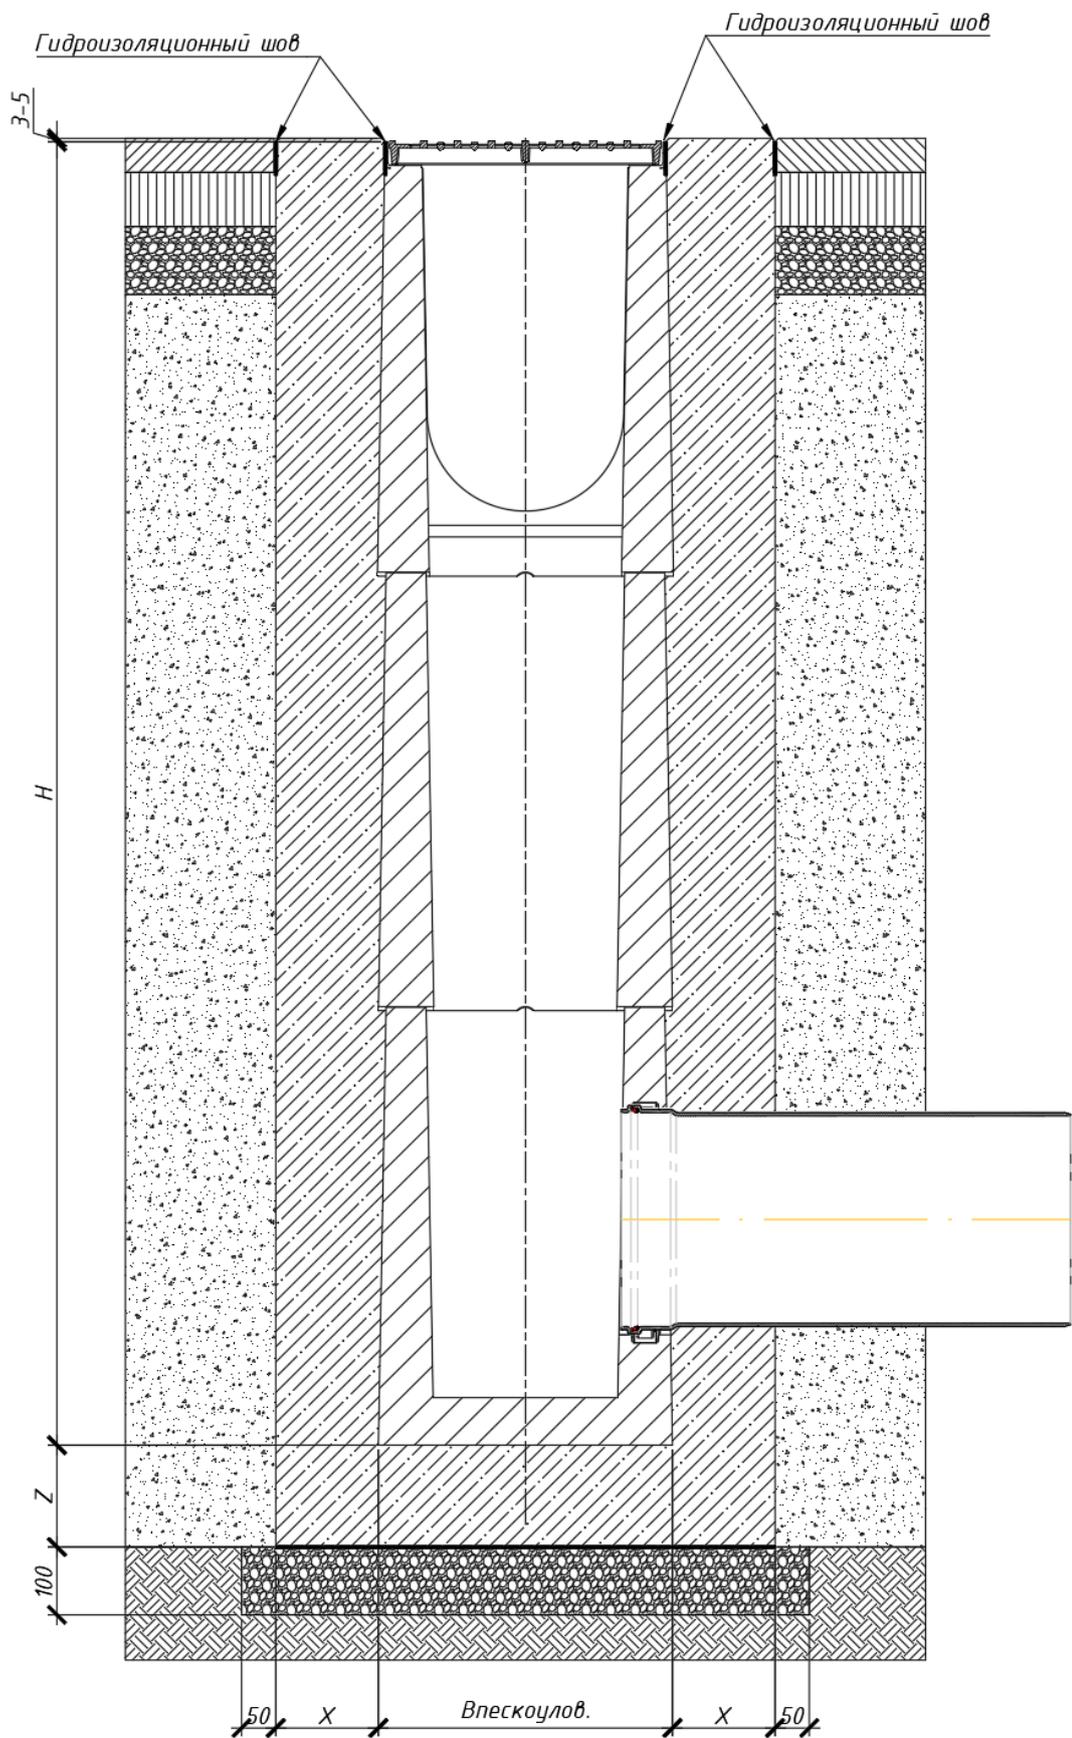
в – Устройство бетонной ободы трехсекционного пескоуловителя с асфальтобетонным покрытием для классов нагрузки от С250 до F900.
